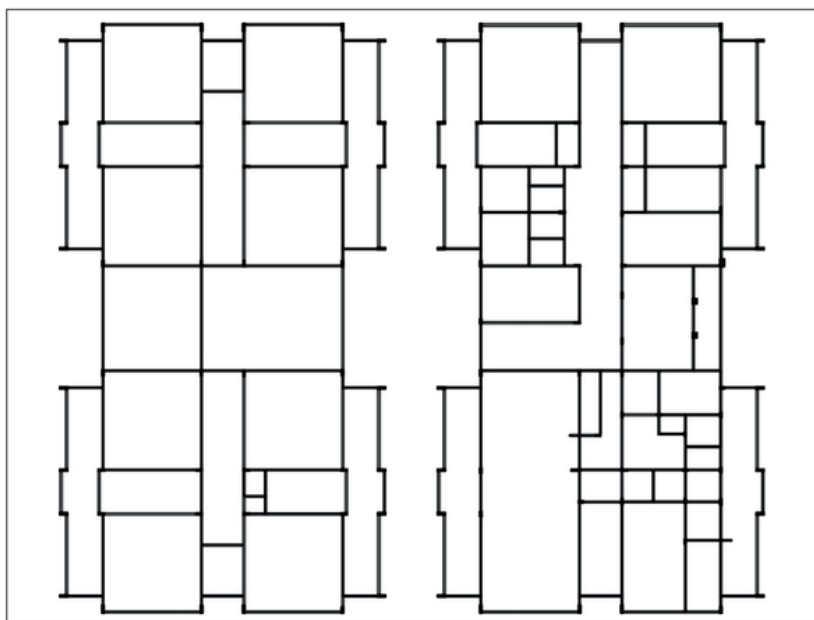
Planta de fôrma do projeto Proinfância – Tipo 1 (FNDE (2018))
